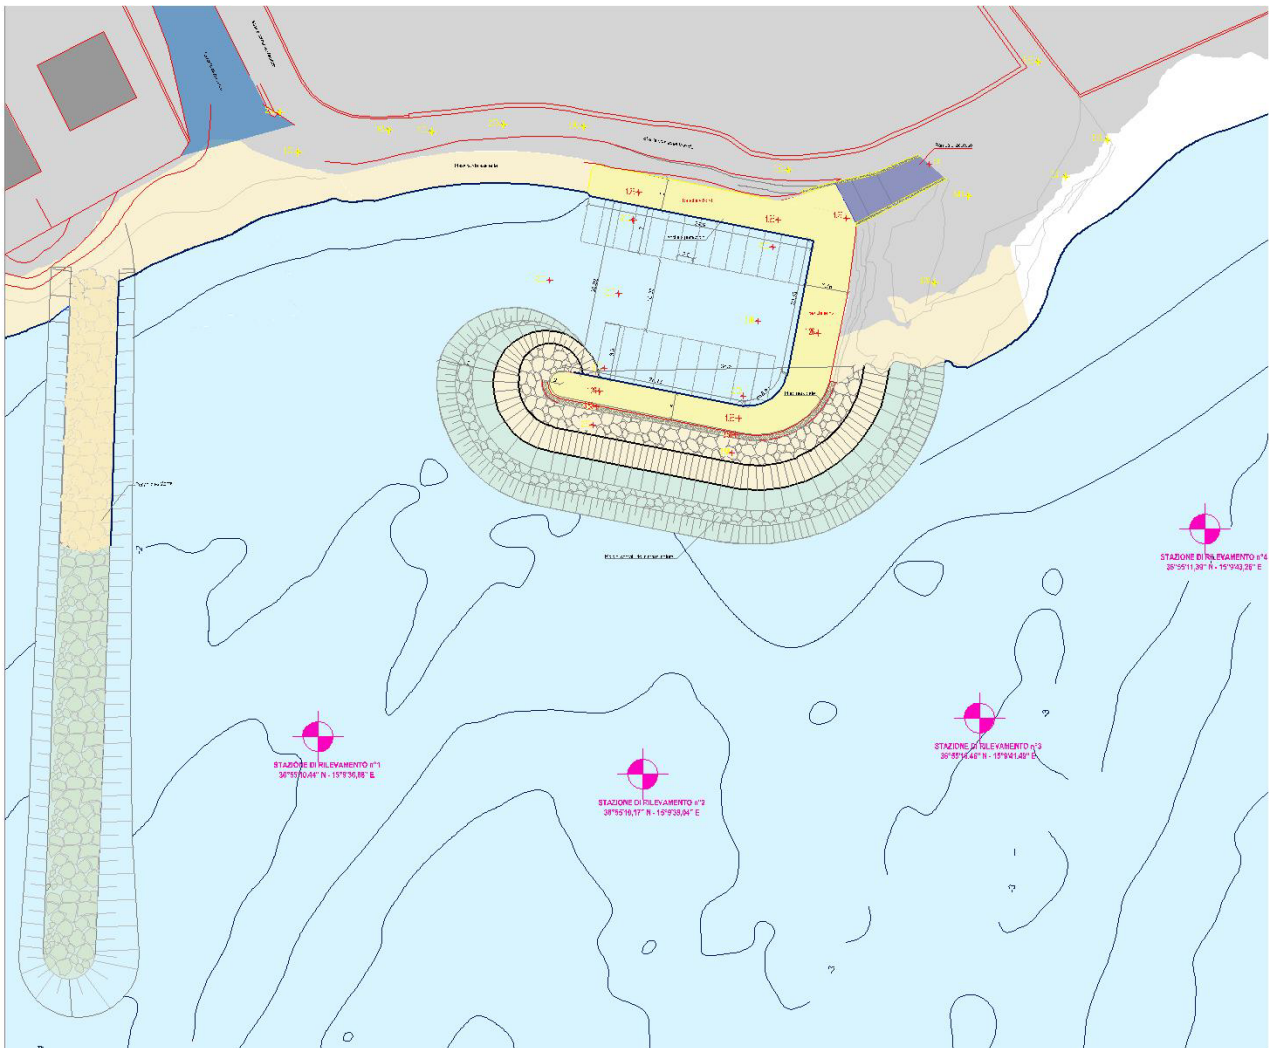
Planimetria di progetto con individuazione delle stazioni di rilevamento
